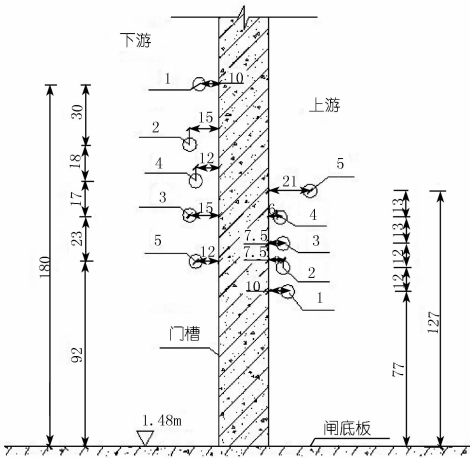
水闸闸墩混凝土芯样的取样位置(尺寸单位:cm)
